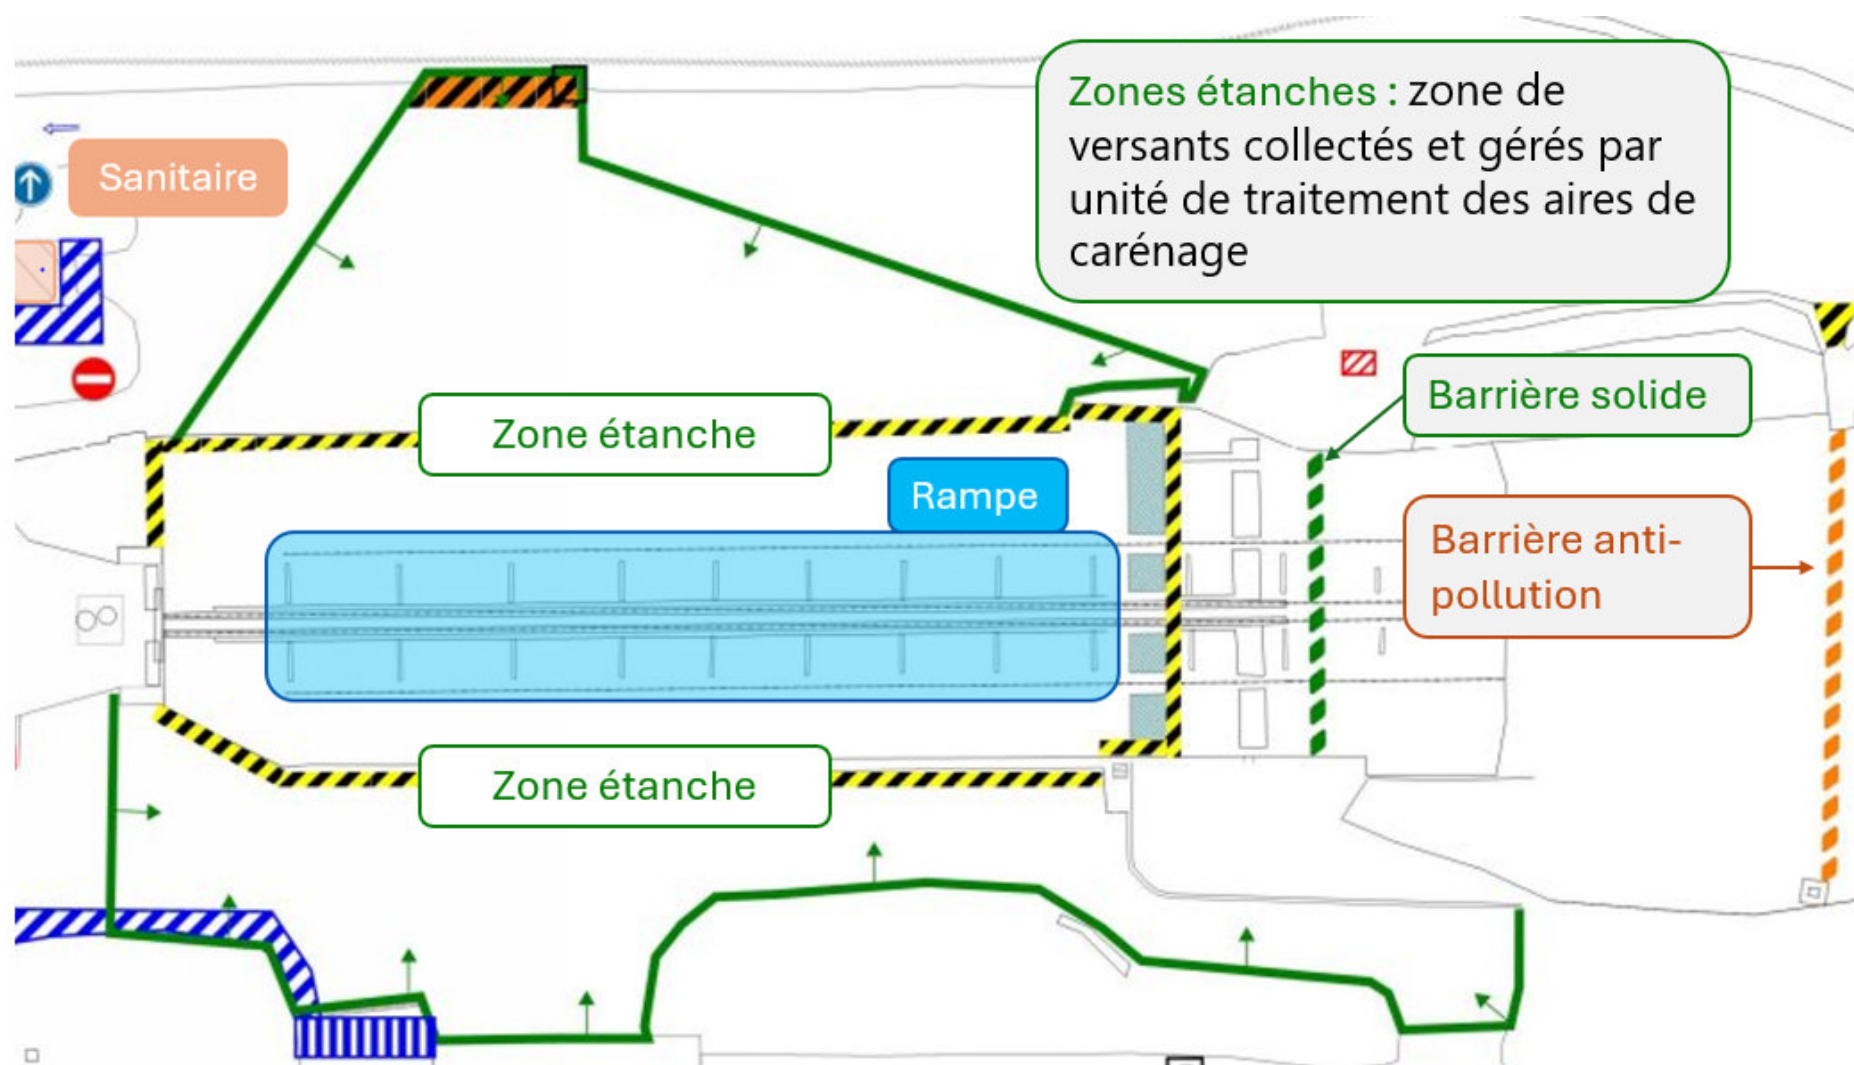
Zones étanches de la cale de halage 1000 T en vert
